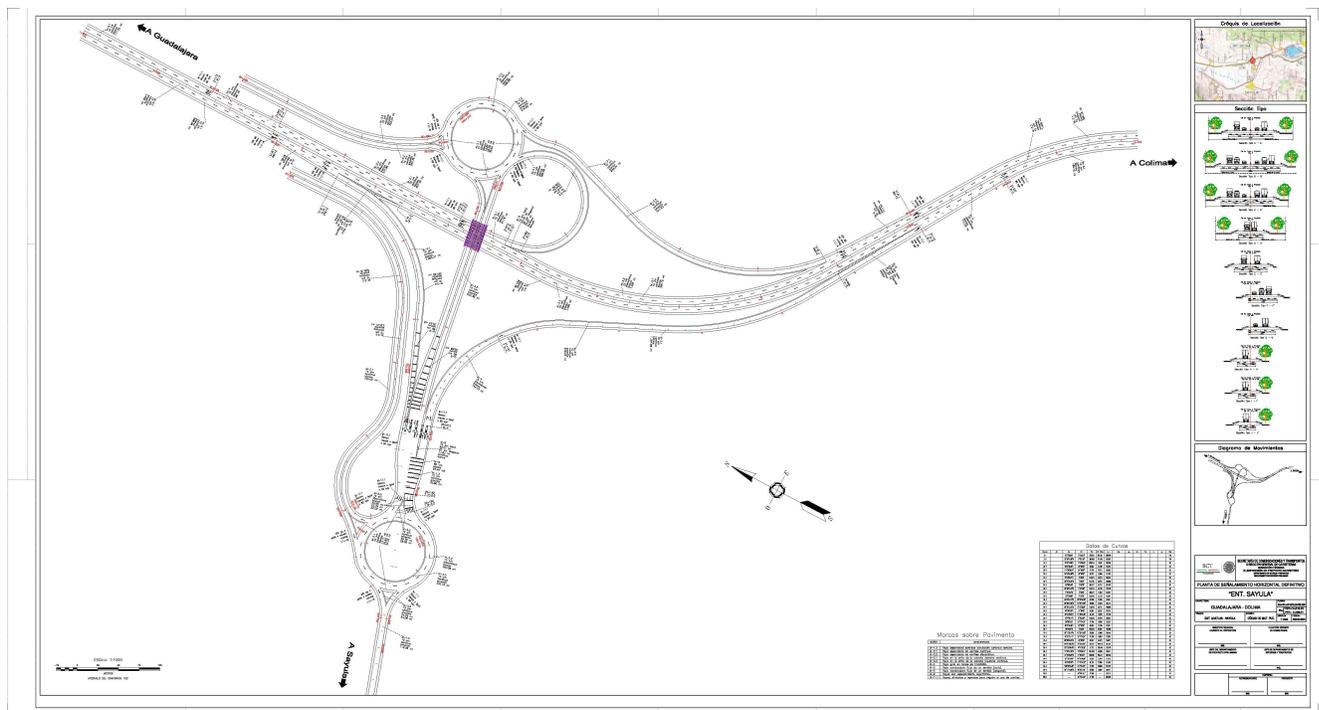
Planta de Señalamiento Horizontal Definitivo.
